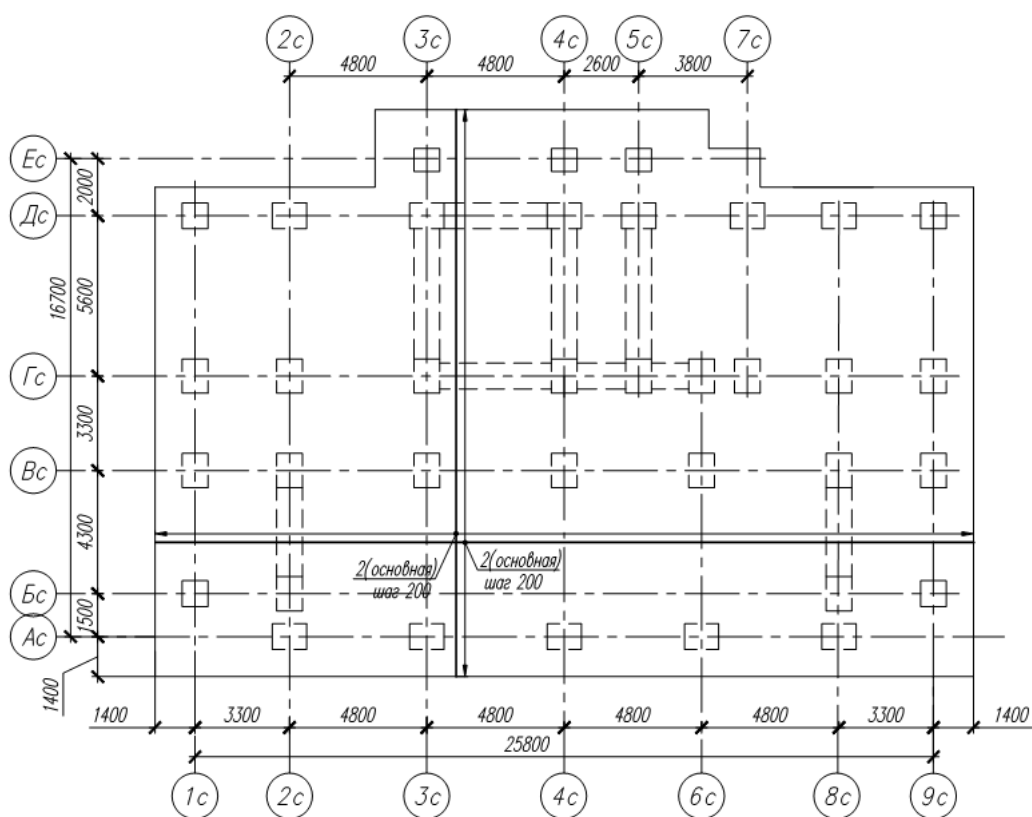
Схема расположения нижней арматуры ф/б фундамента
